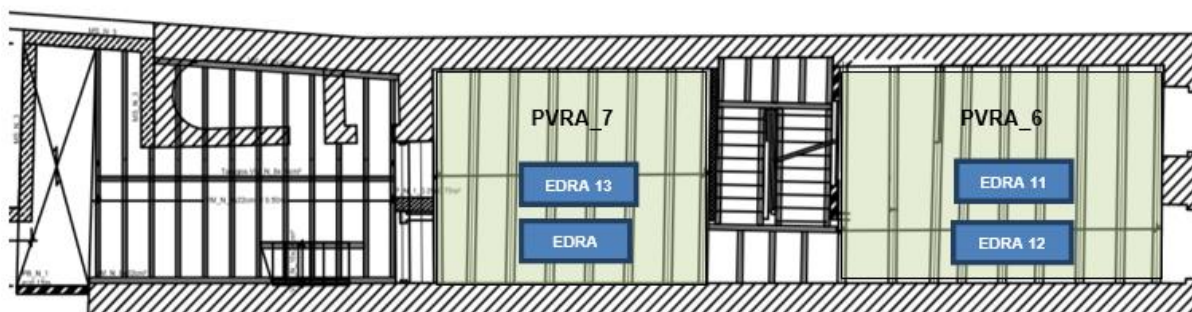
Planta do piso 1, com identificação esquemática dos pavimentos e ensaios dinâmicos
